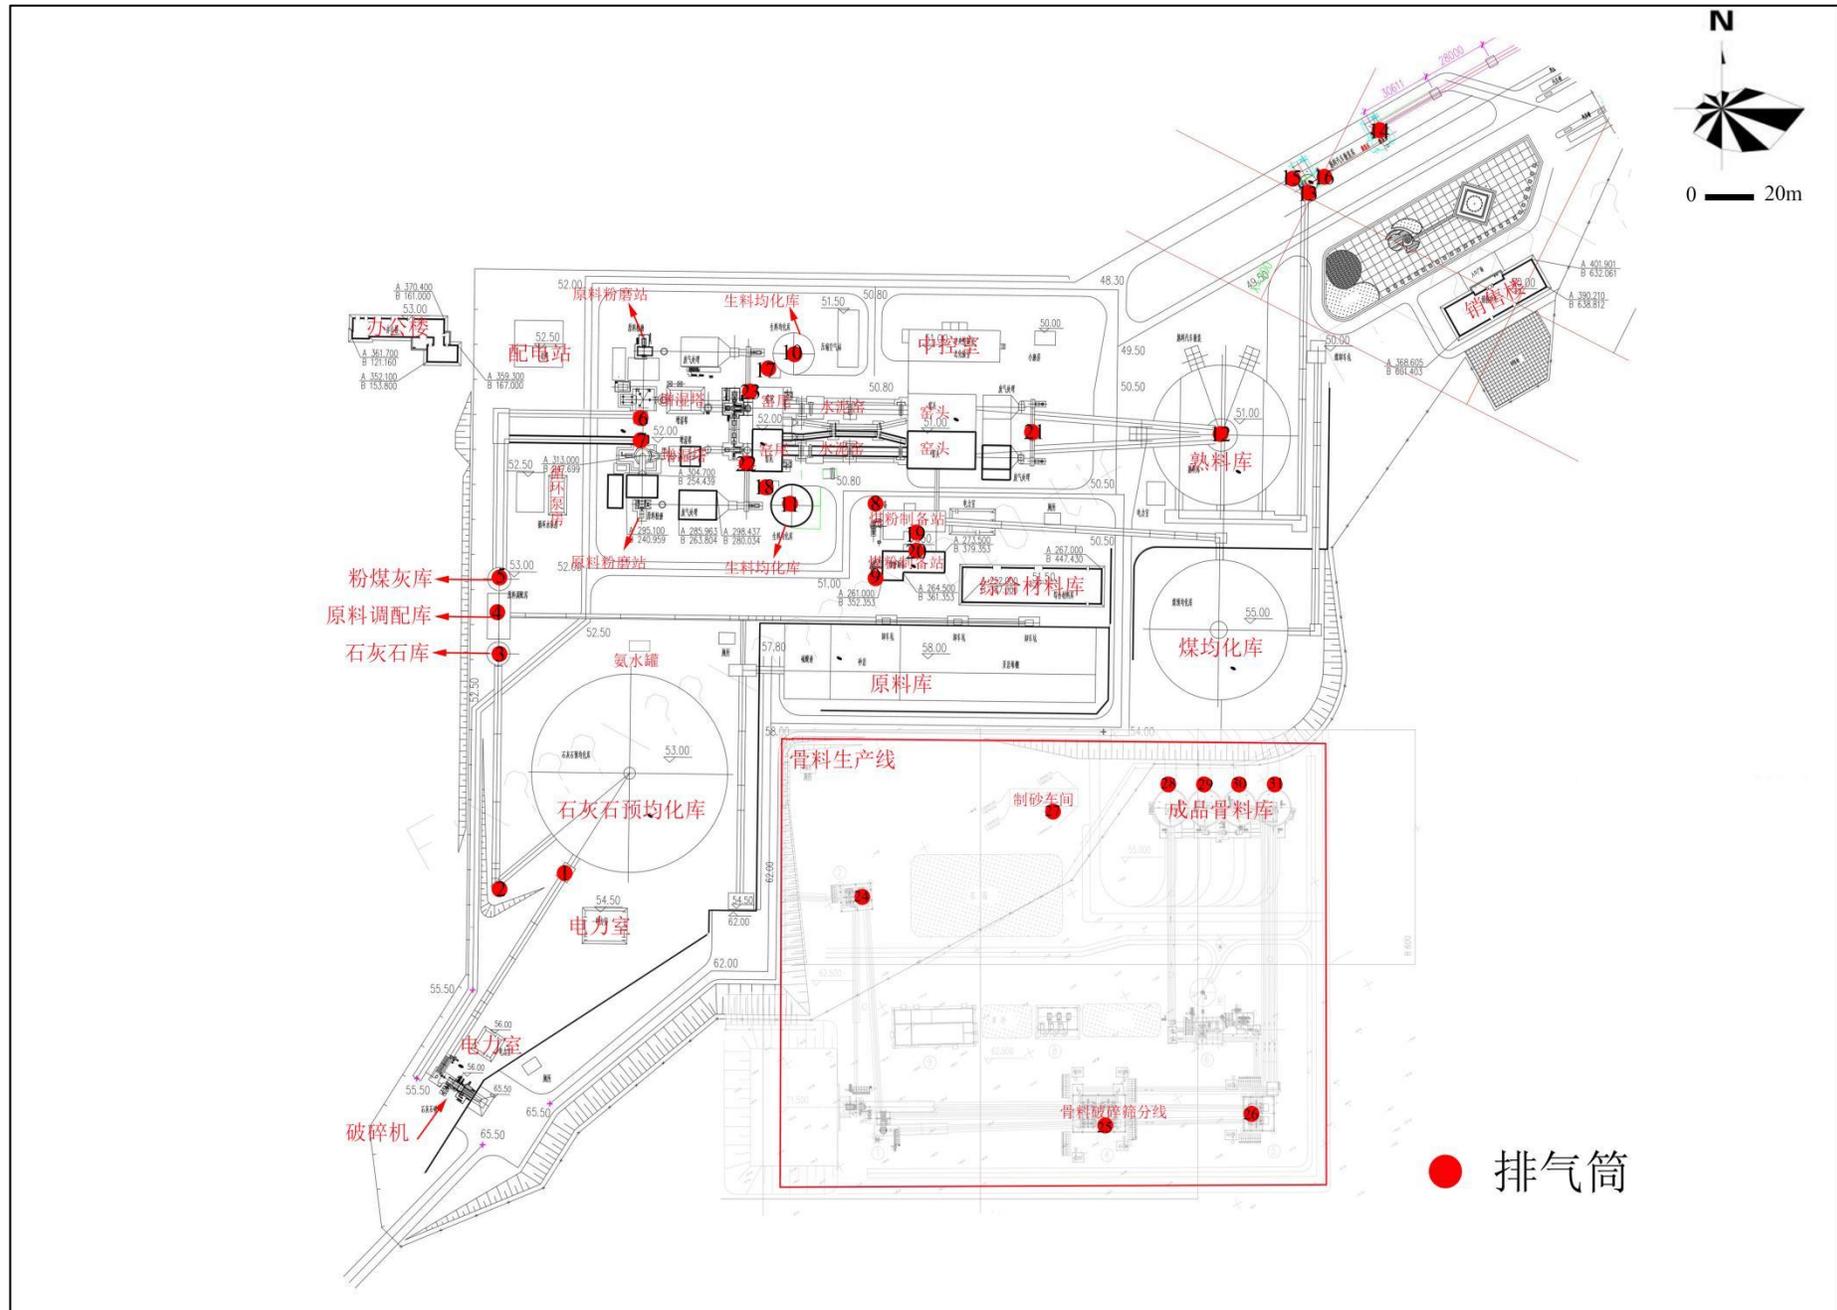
水泥熟料厂区现状总平面布置图
